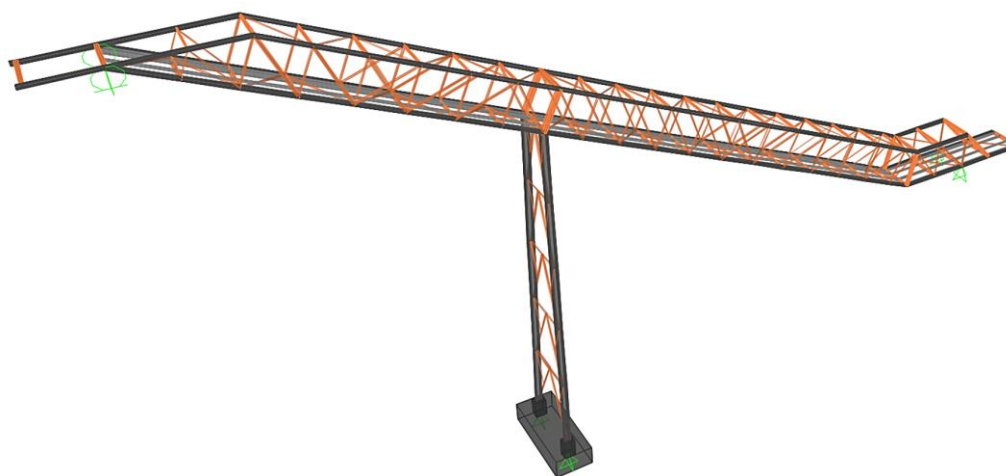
Vista da Ponte e do Pilar Metálico
